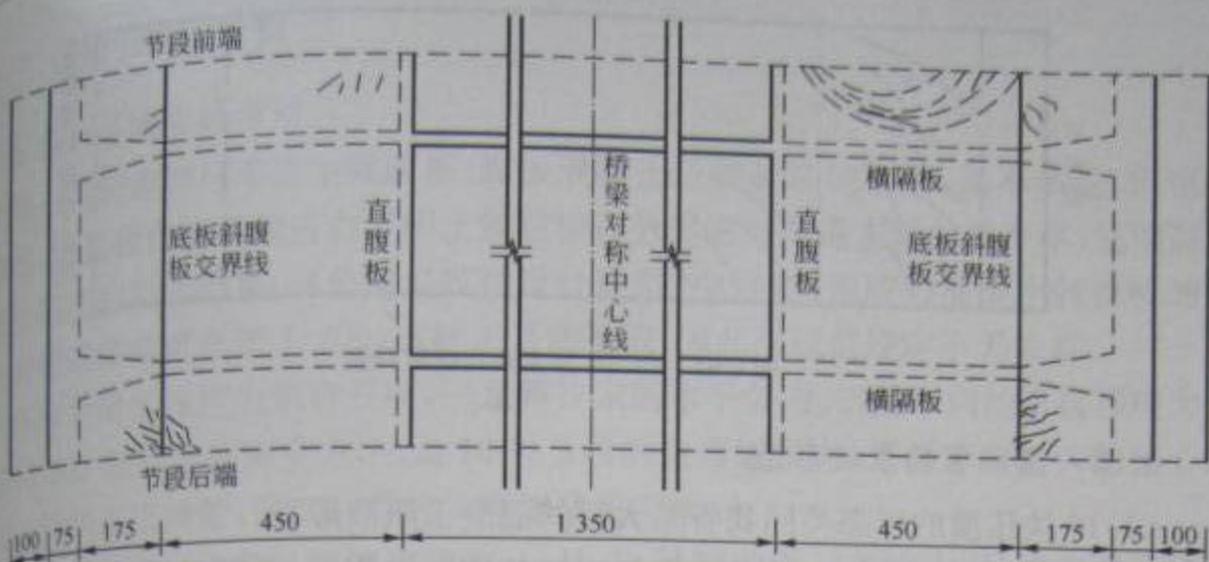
底板、斜腹板的裂缝形态(尺寸单位:mm)
